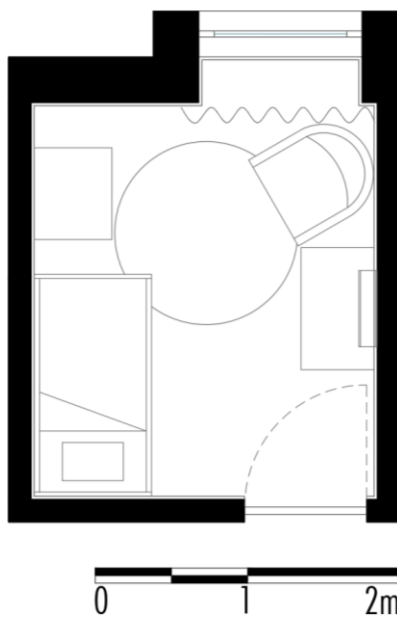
Planta proposta 1 (Fonte: Autora, 2022)
